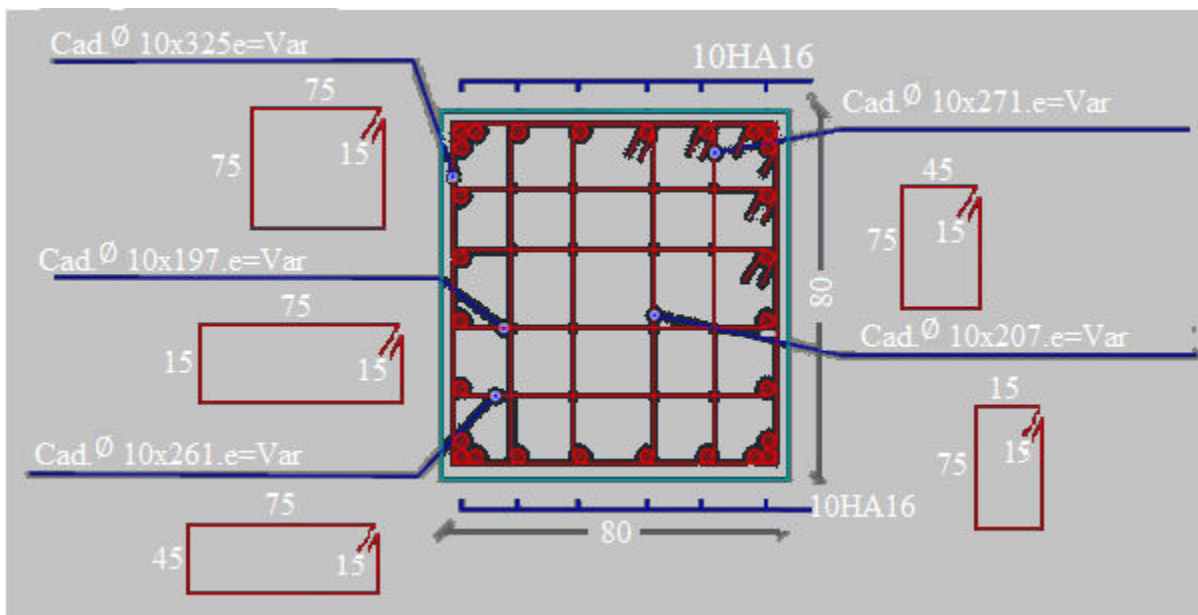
Coupe de ferrailage des poteaux 80×80 cm<sup>2</sup>
